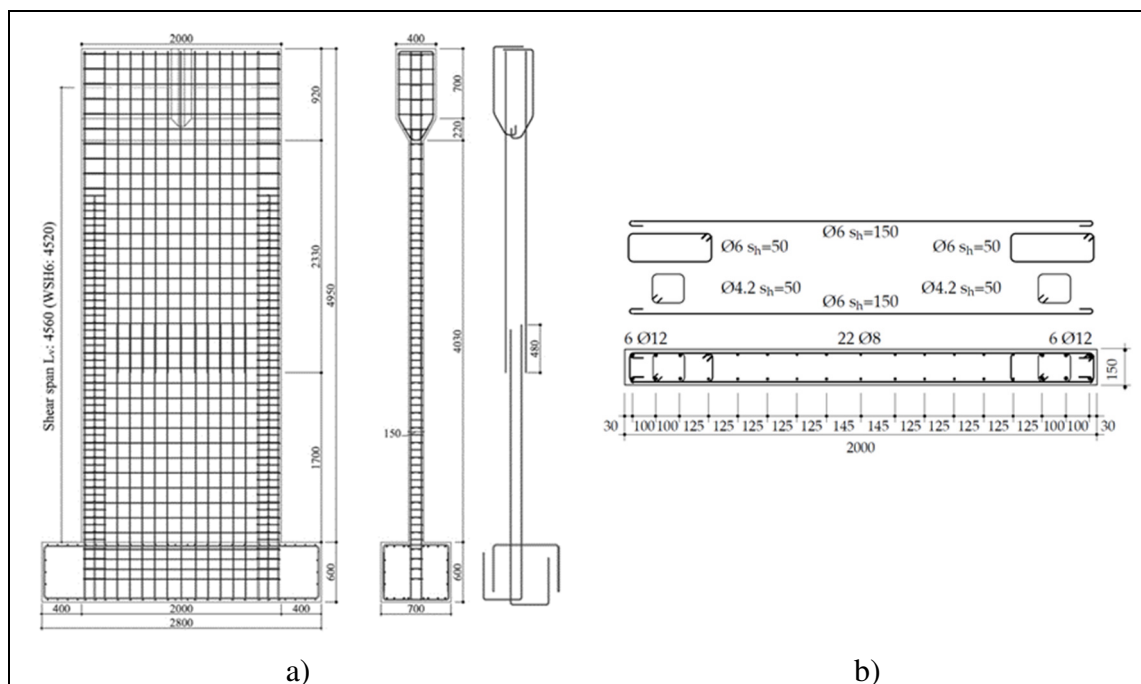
Muro WSH6, dimensiones en mm (Dazio, Beyer & Bachmann, 2009). a) Elevación. b) Vista en planta.
